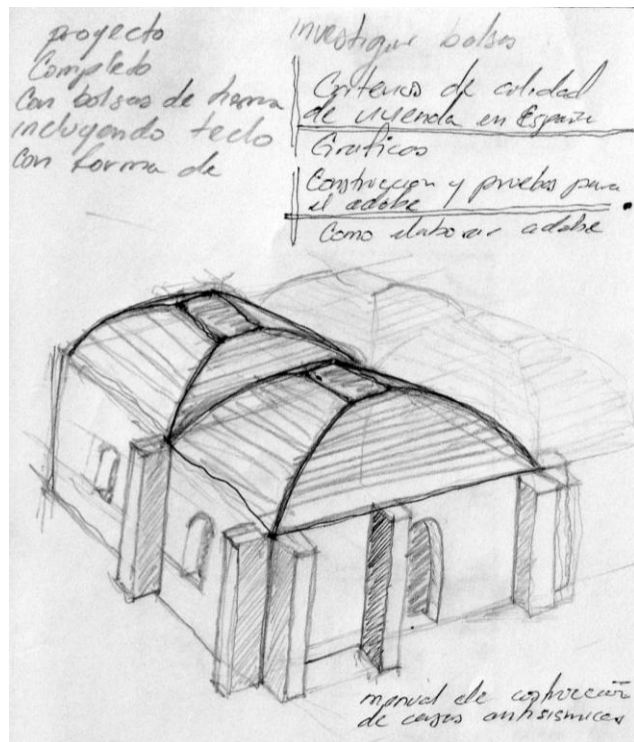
Primera boceto; planta rectangular y techo de bóveda (Imagen: Autor\*)
